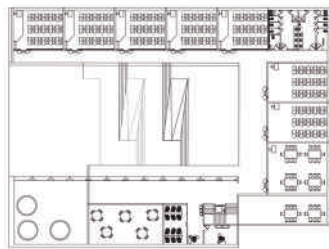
Planta CFT Nivel -1. Fuente: Elaboración propia.
